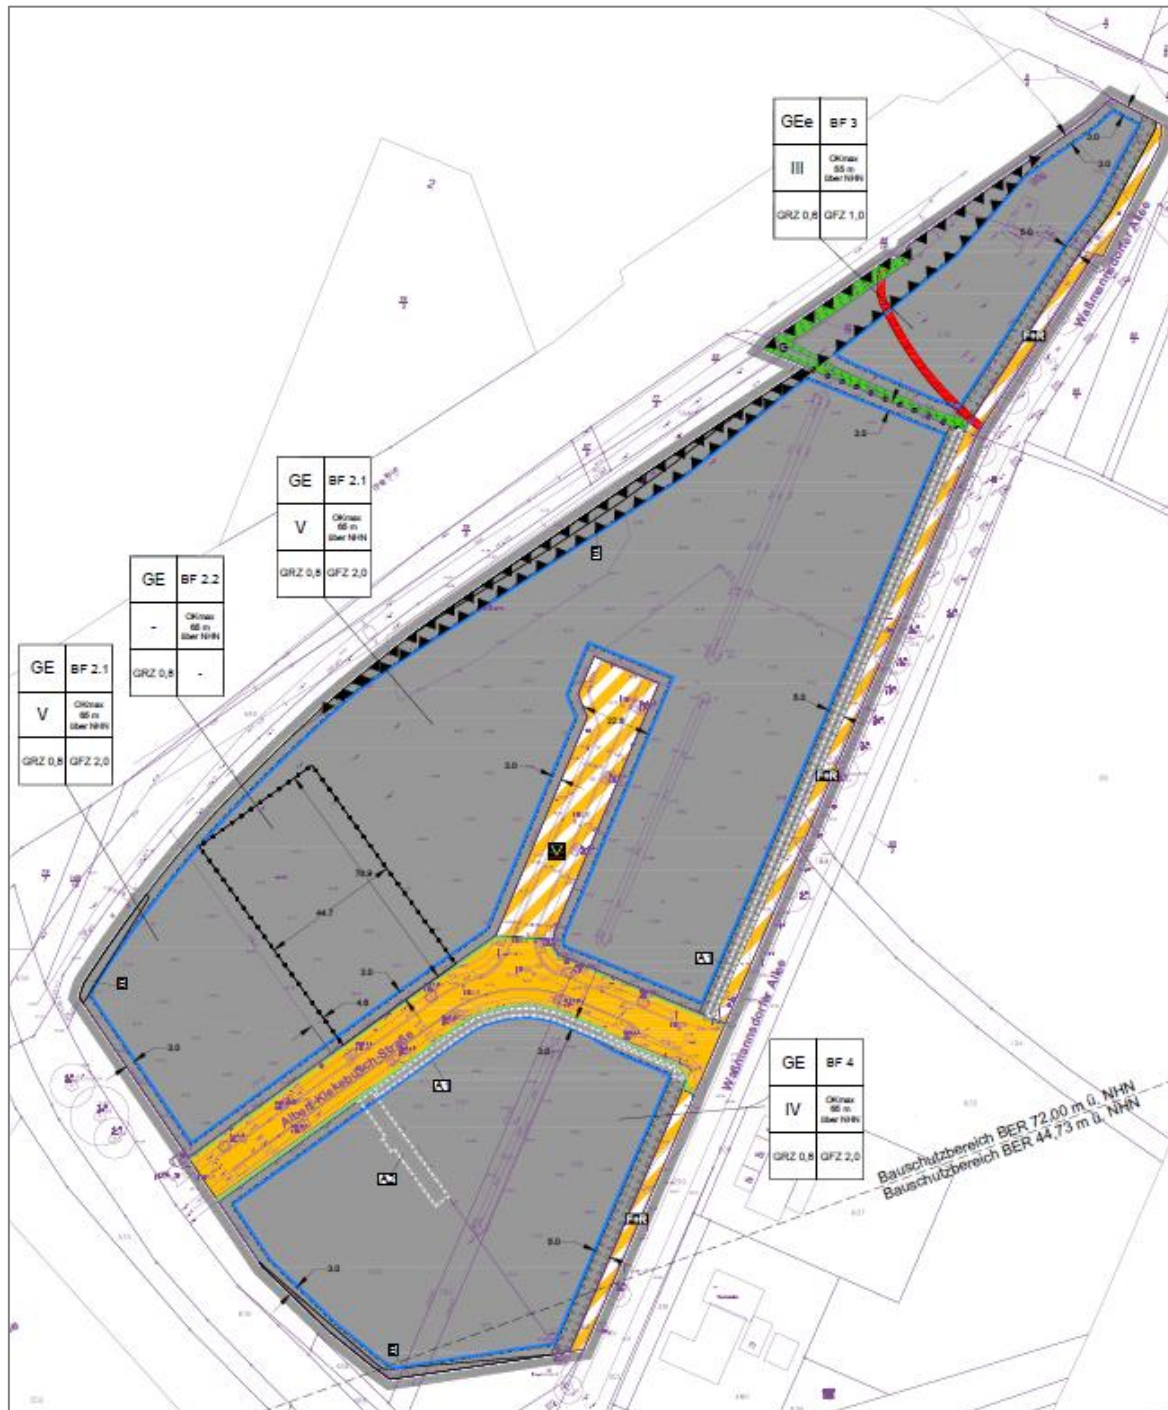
Bebauungsplan 02/22 „Gewerbepark am Airport- Teilgebiet Ost“ (Entwurf, Stand: 16.12.2022)
